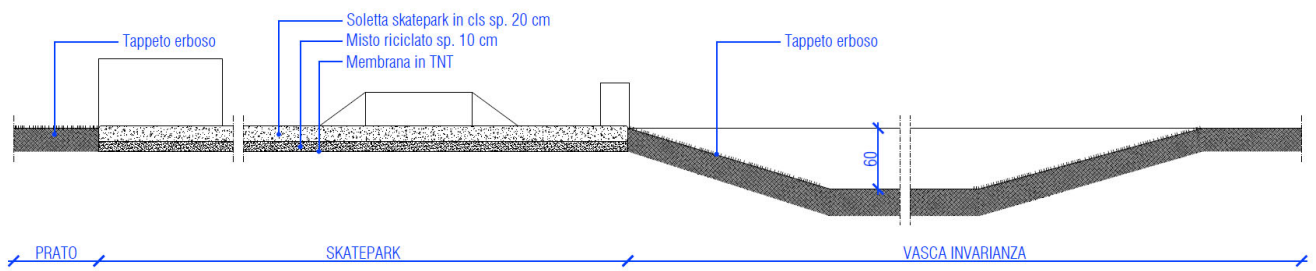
Sezione B-B (Area a prato, Skatepark e vasca di laminazione)
